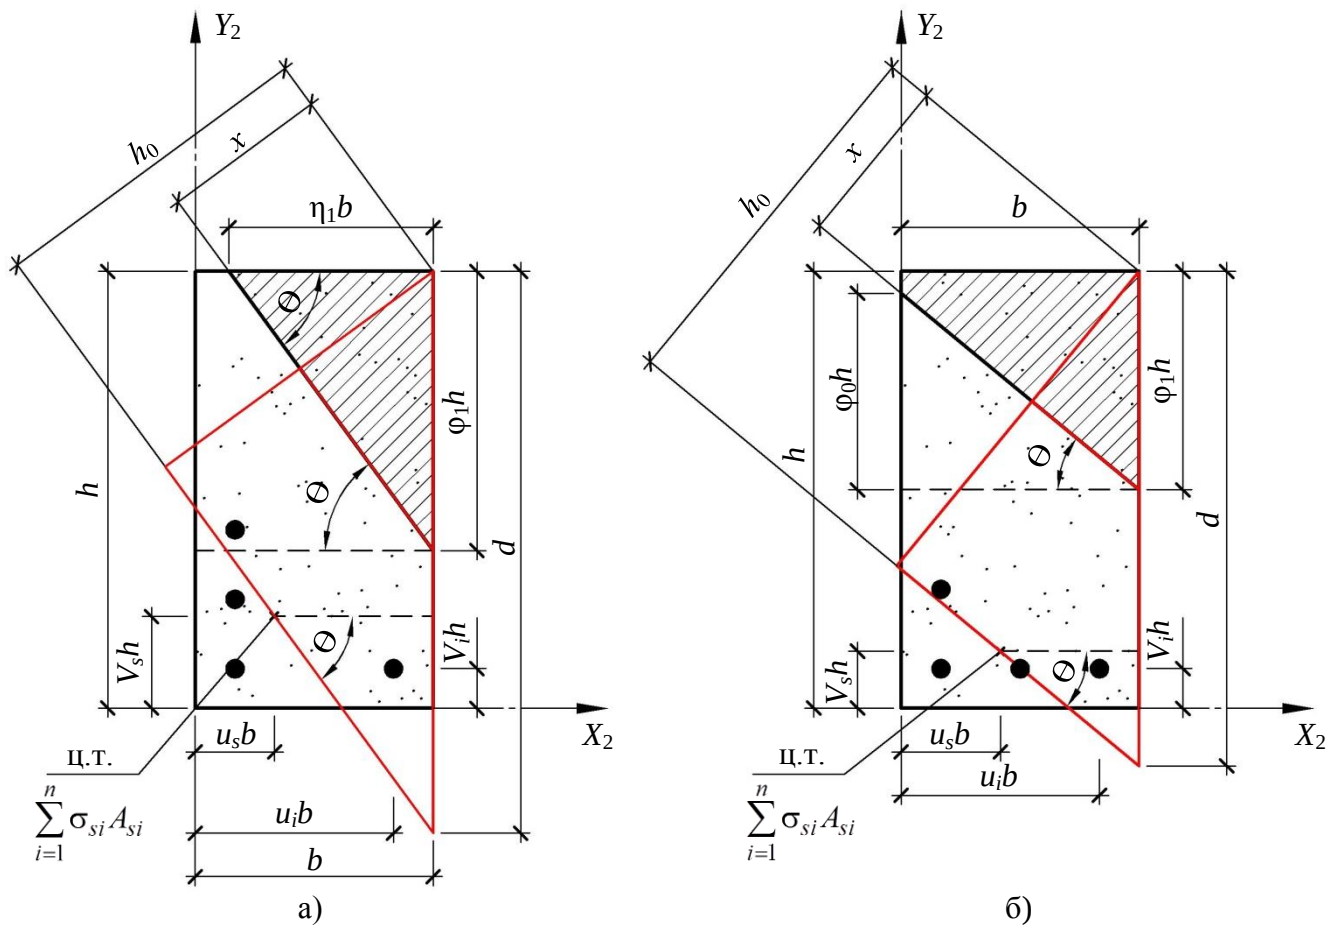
Схема определения относительной высоты сжатой зоны в косоизгибаемом фиброжелезобетонном элементе для треугольной (а) и трапециевидной (б) форм сжатой зоны фибробетона
